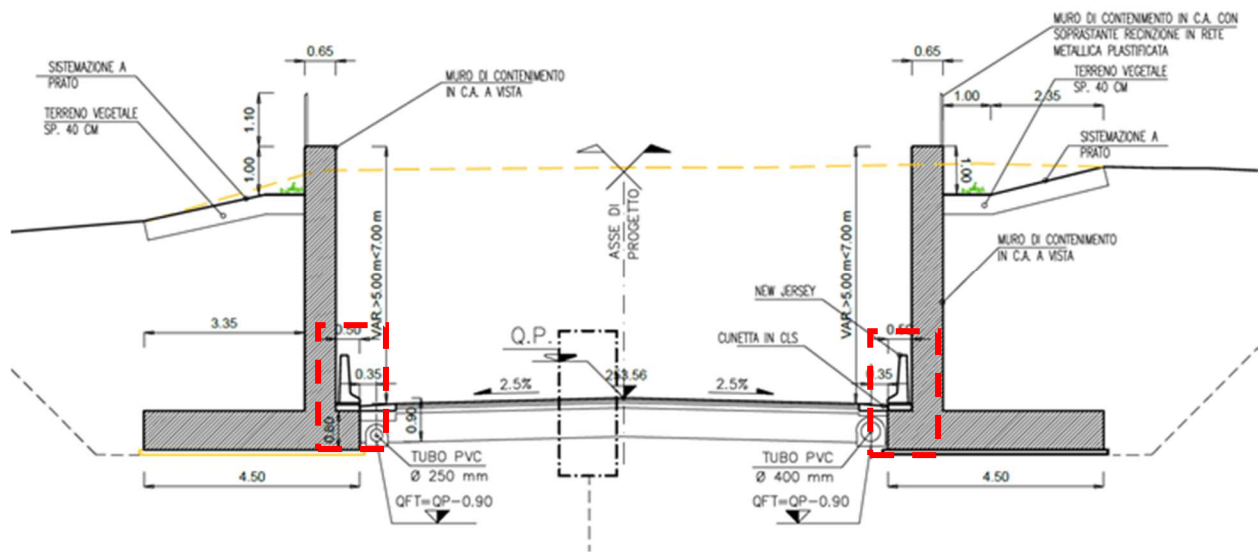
New Jersey a protezione dei muri di contenimento
